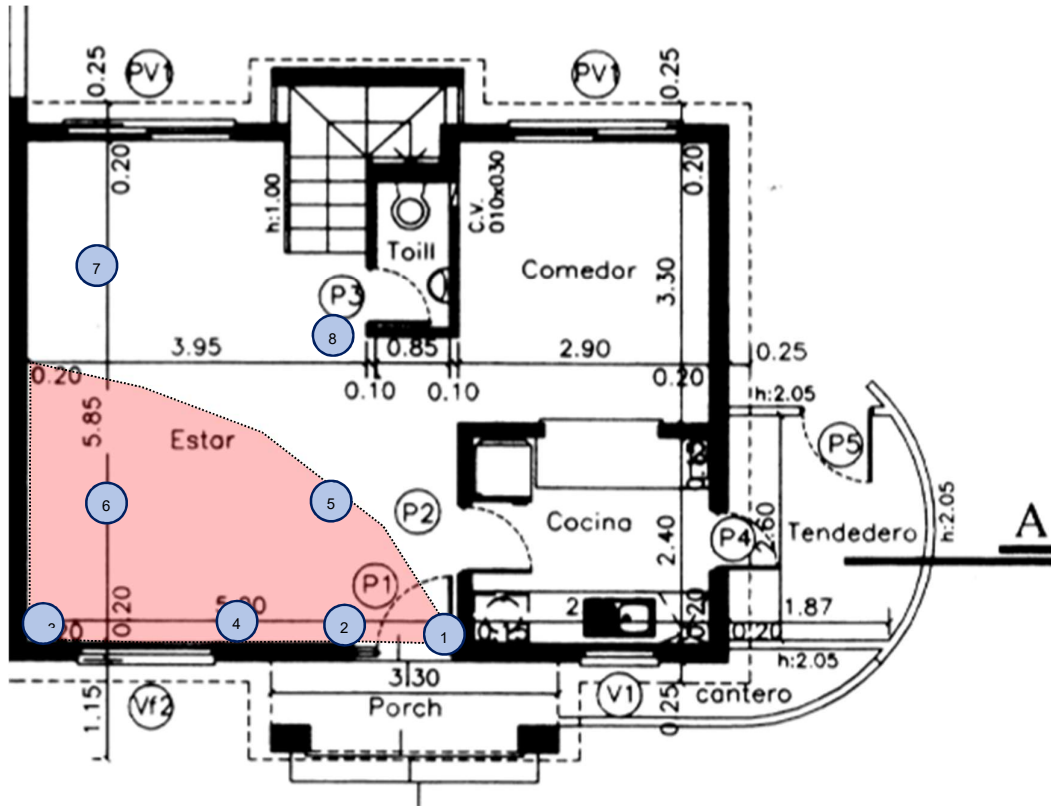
Arquitectura Planta Baja - Casa 46
